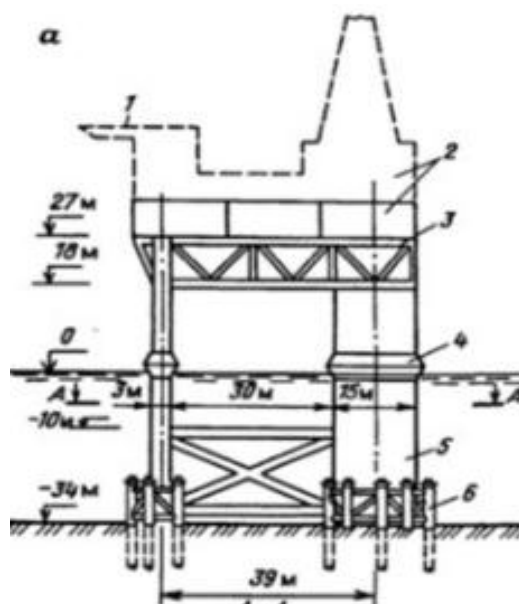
Опорный блок стальной ледостойкой платформы со свайным фундаментом: 1 – вертолетная площадка; 2 – блок-модули верхнего строения платформы; 3 – палуба; 4 – ледорезное устройство; 5 – опорные колонны; 6 – юбочные сваи
